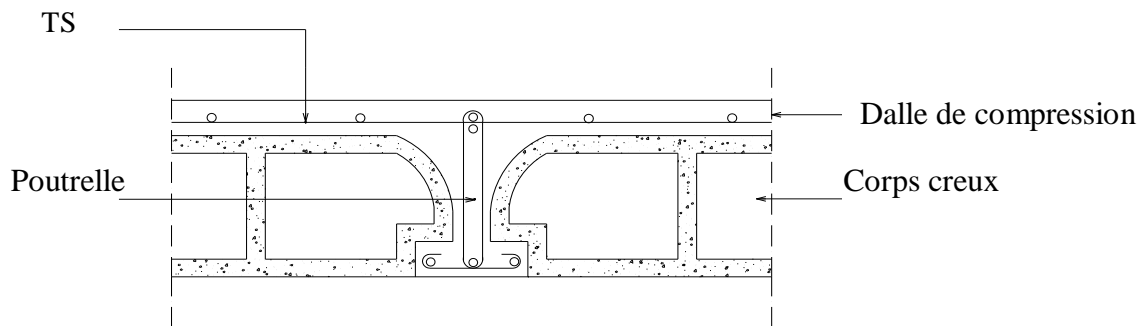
Coupe transversale d'un plancher à corps creux
